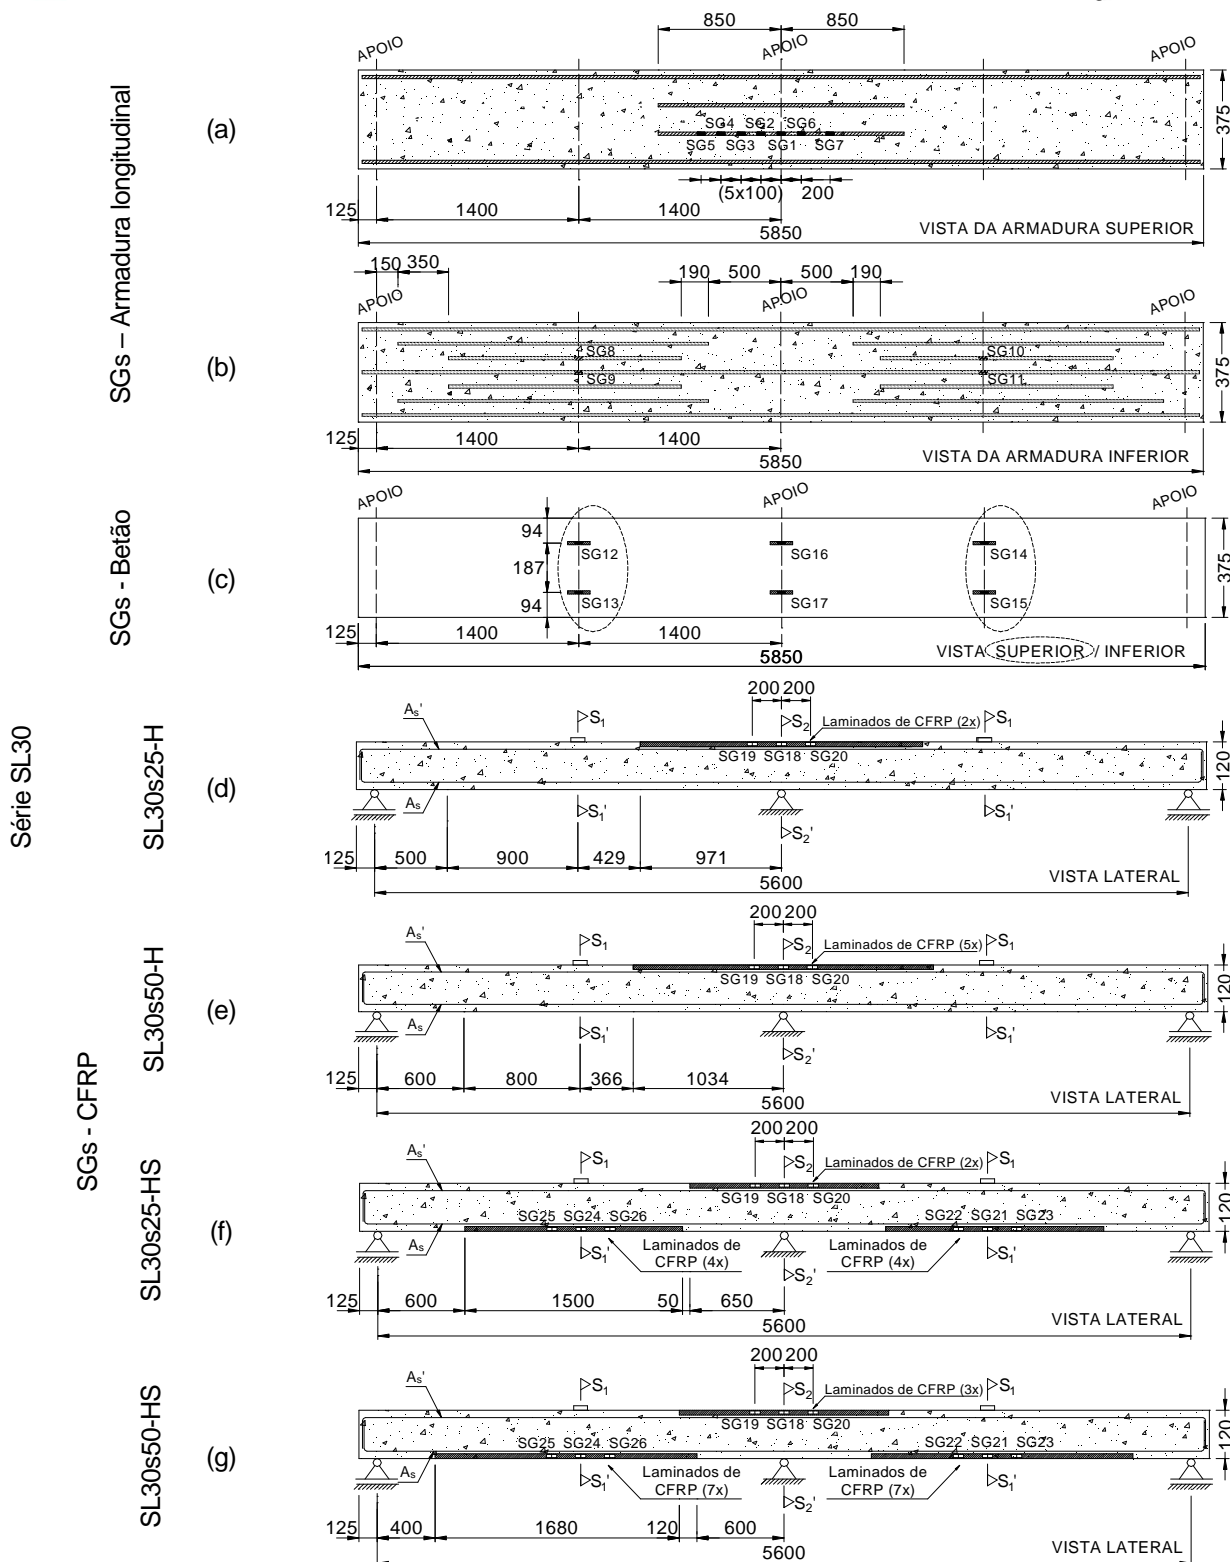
Posicionamento de (a-b) extensômetros nas armaduras longitudinais, (c) betão, (d-g) laminados de CFRP para as faixas de laje reforçada da série SL30 (dimensões em mm).
